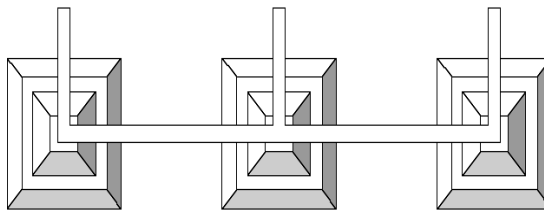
Bentuk Pondasi Pijler dengan tampak samping.
